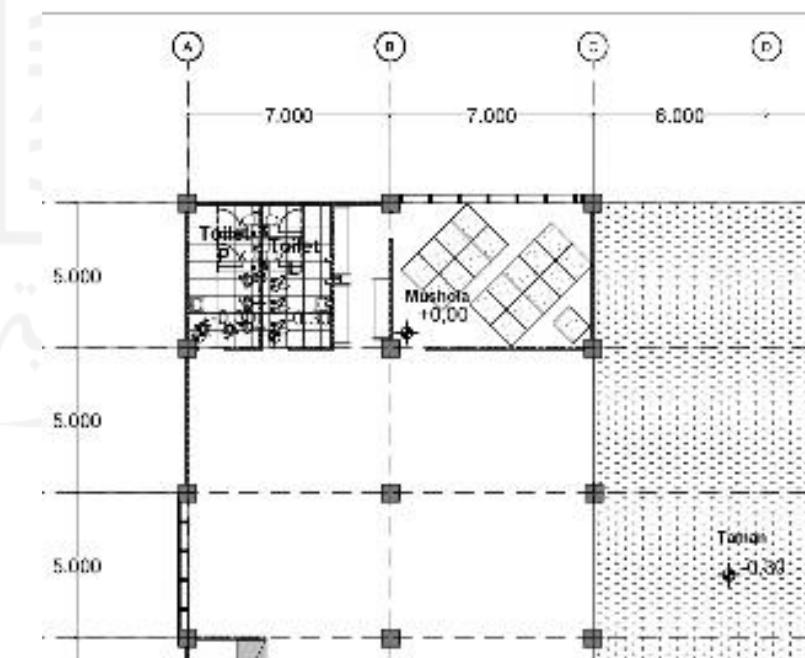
Denah Interior Pasar Kering dan Pujasera
